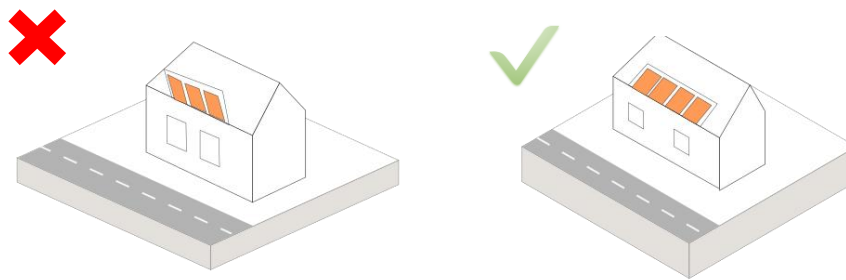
Les panneaux devront être implantés dans un plan parallèle à la toiture
